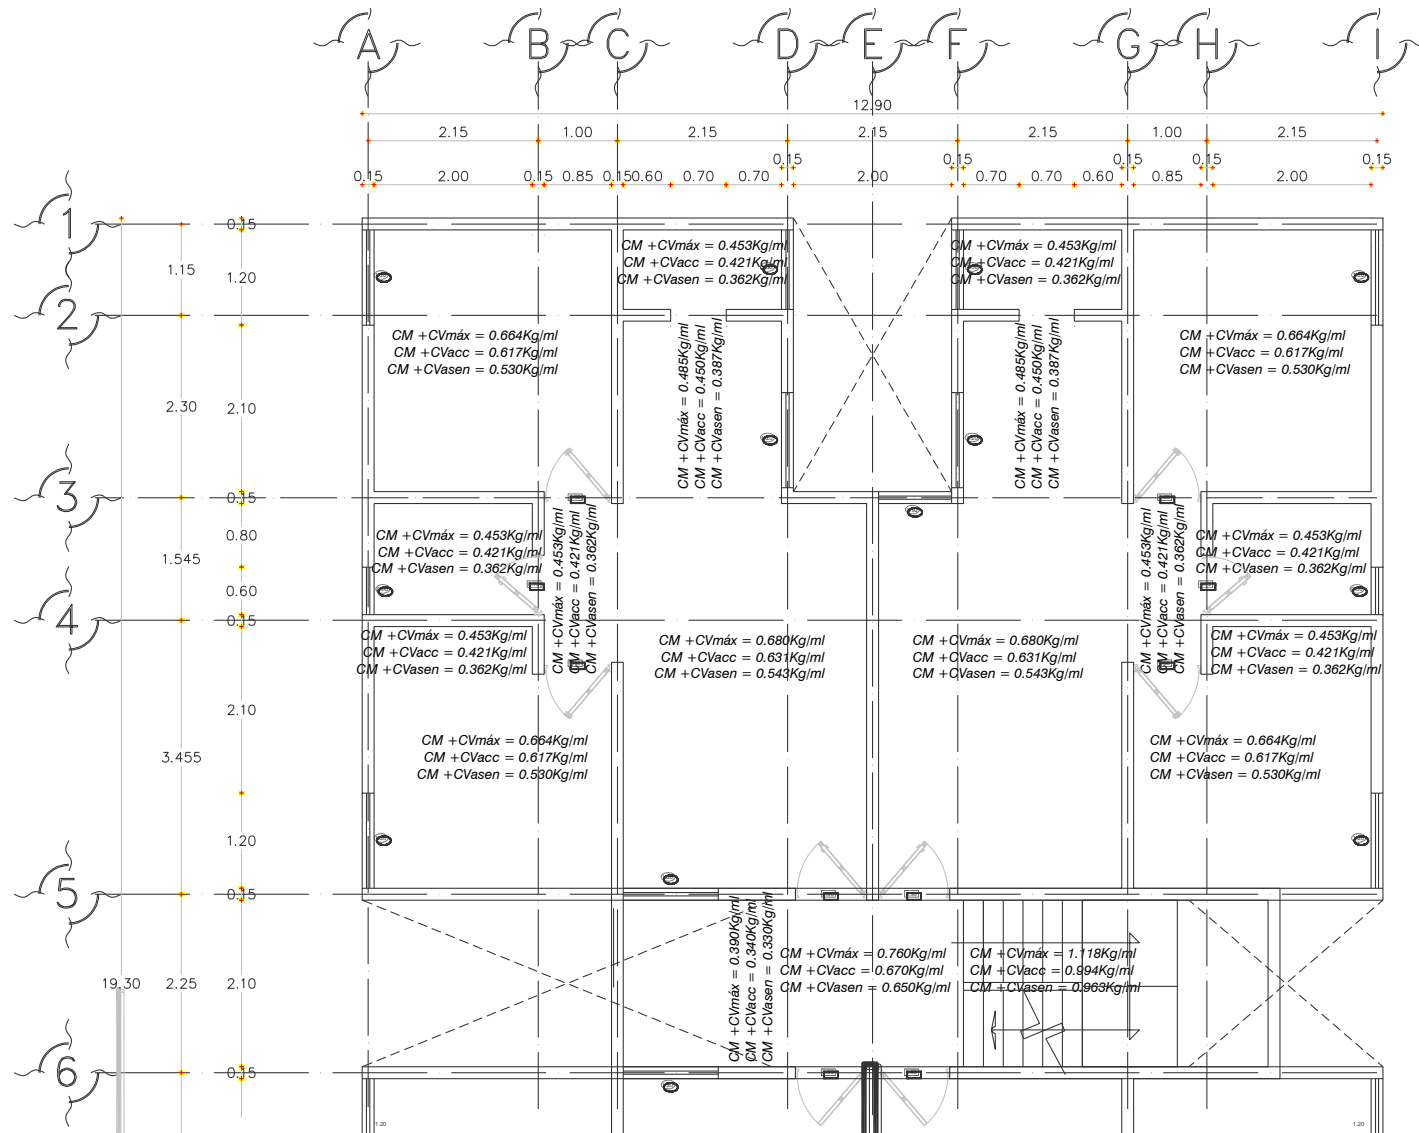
Distribución de cargas en planta azotea (se muestra la mitad de la planta).
